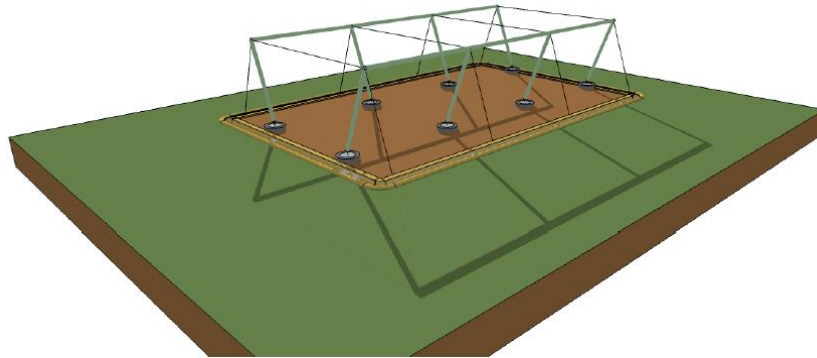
Estructura principal bambú, cable acerado y cimentaciones de llantas de reforzadas con varilla de construcción #2. (Ver detalle corte de las láminas arquitectónicas)
